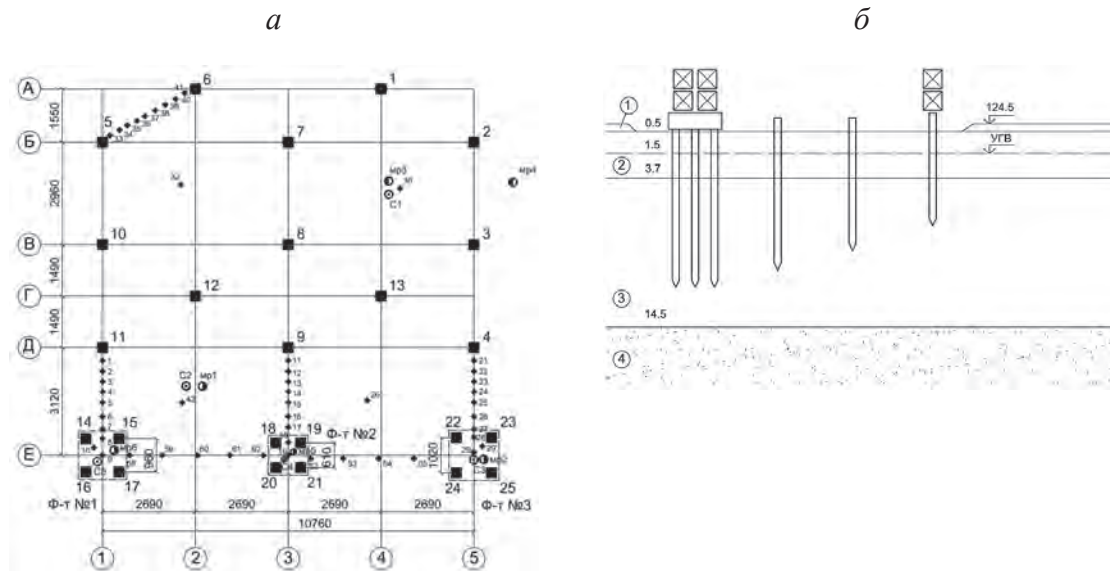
Экспериментальная площадка в плане а и разрезе б:
